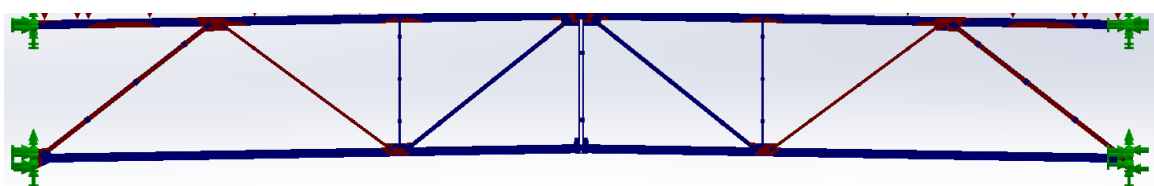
Металева ферма каркасу цеху виготовлення будівельних конструкцій
